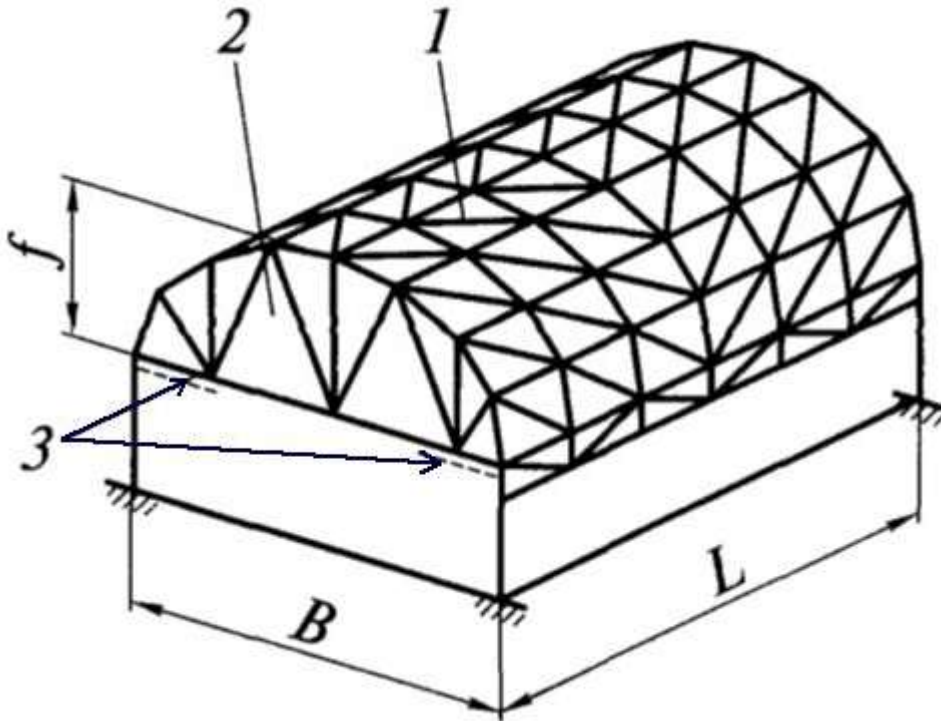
Схема сетчатой цилиндрической оболочки: 1 – сетка оболочки; 2 – торцевая диафрагма; 3 – связи
